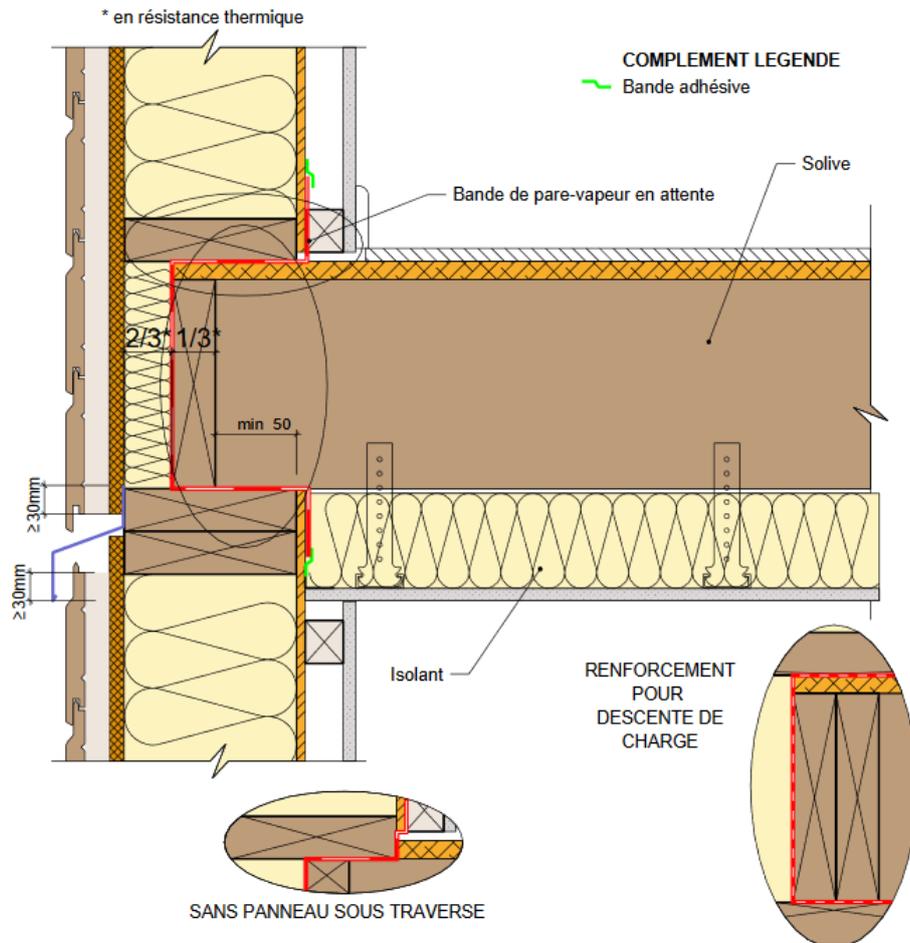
Exemple de jonction au droit d'un plancher d'étage sur lisse haute (coupe verticale)
